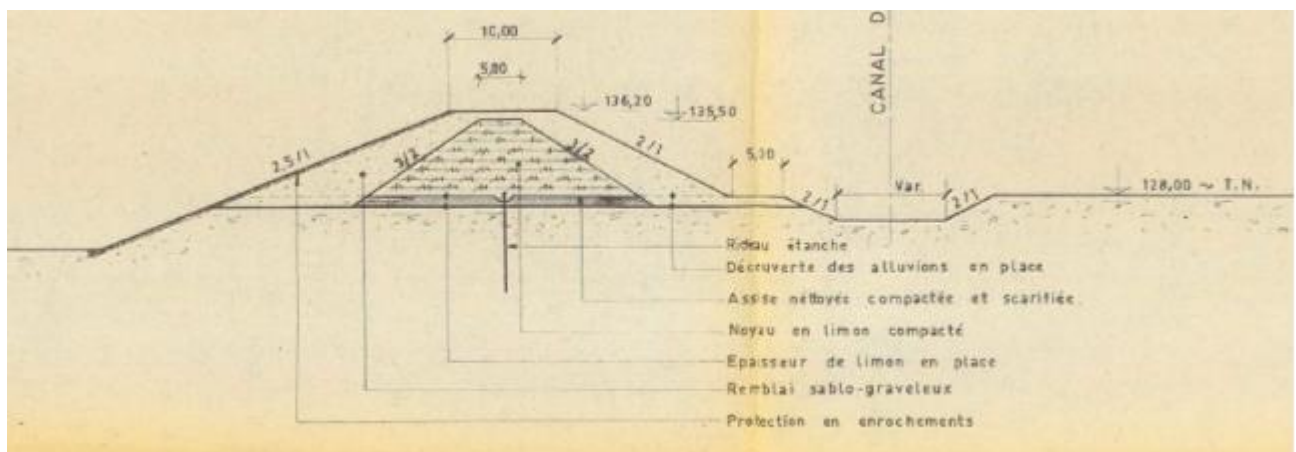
Coupe transversale du barrage de canalisation rive droite du Rhin au PK 308,700 (amont barrage)
